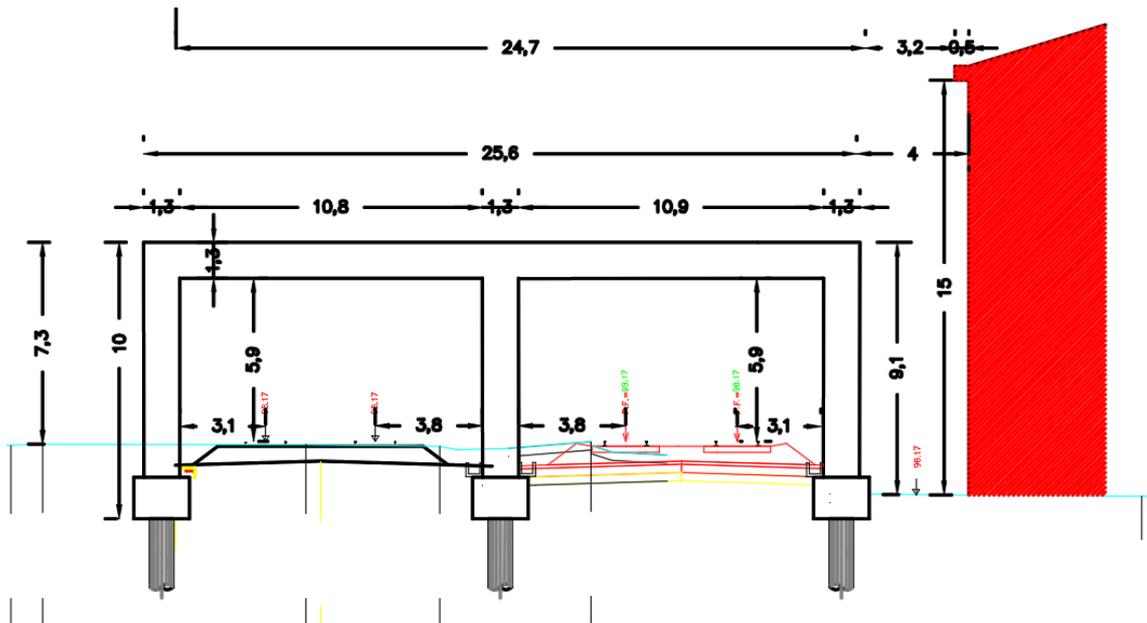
Sezione A-A-Galleria artificiale alla pk 8+000
